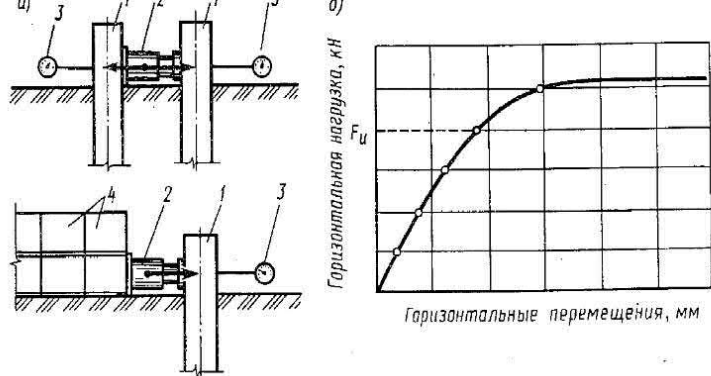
Испытания свай горизонтальной нагрузкой:
